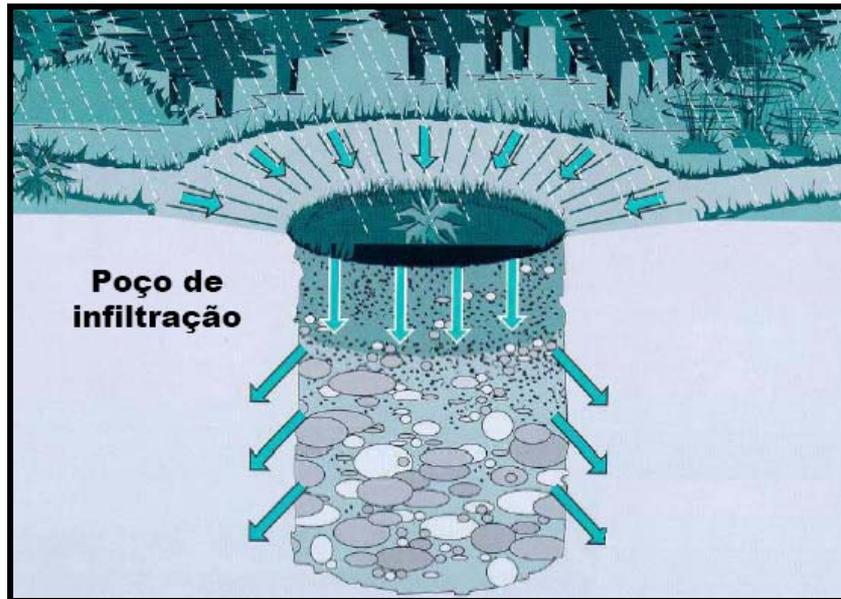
Perfil de um poço de infiltração (Baptista, 2006).
